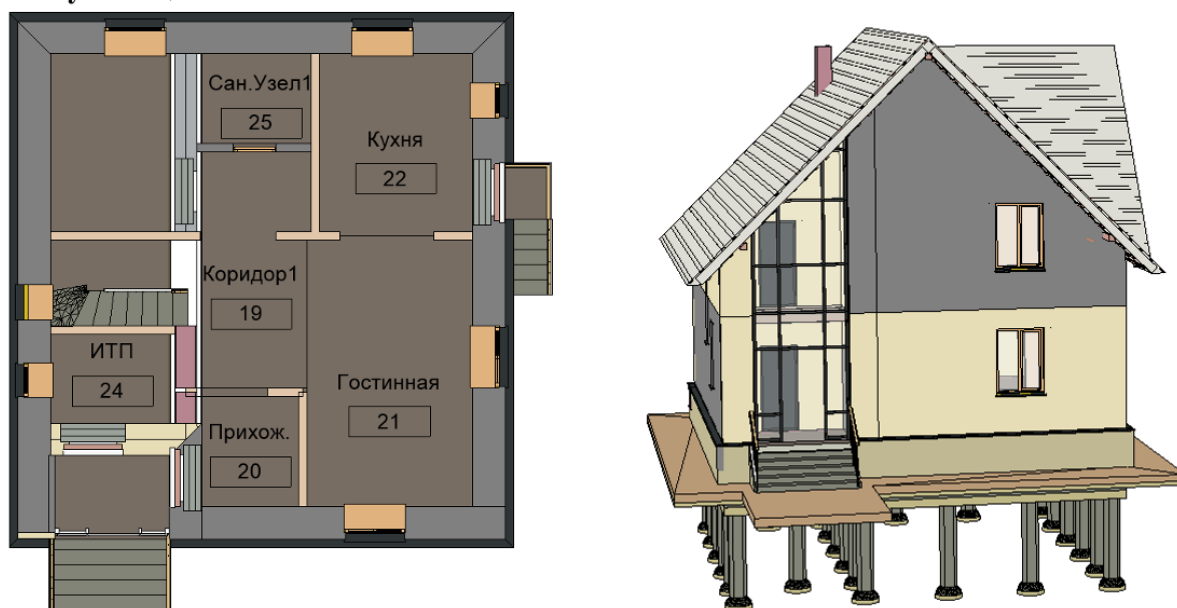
План 1-го этажа и 3D вид малоэтажного жилого здания
